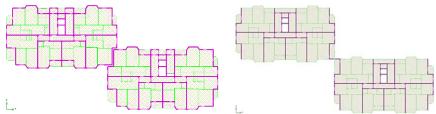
Варианты расчётных схем: слева – здание с монолитными продольными и поперечными стенами; справа – здание с монолитными поперечными стенами и с продольными из пенобетонного заполнения
